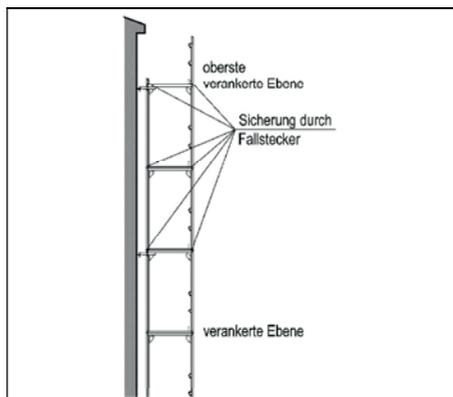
Gerüst an Gebäude mit geringer Dachneigung
